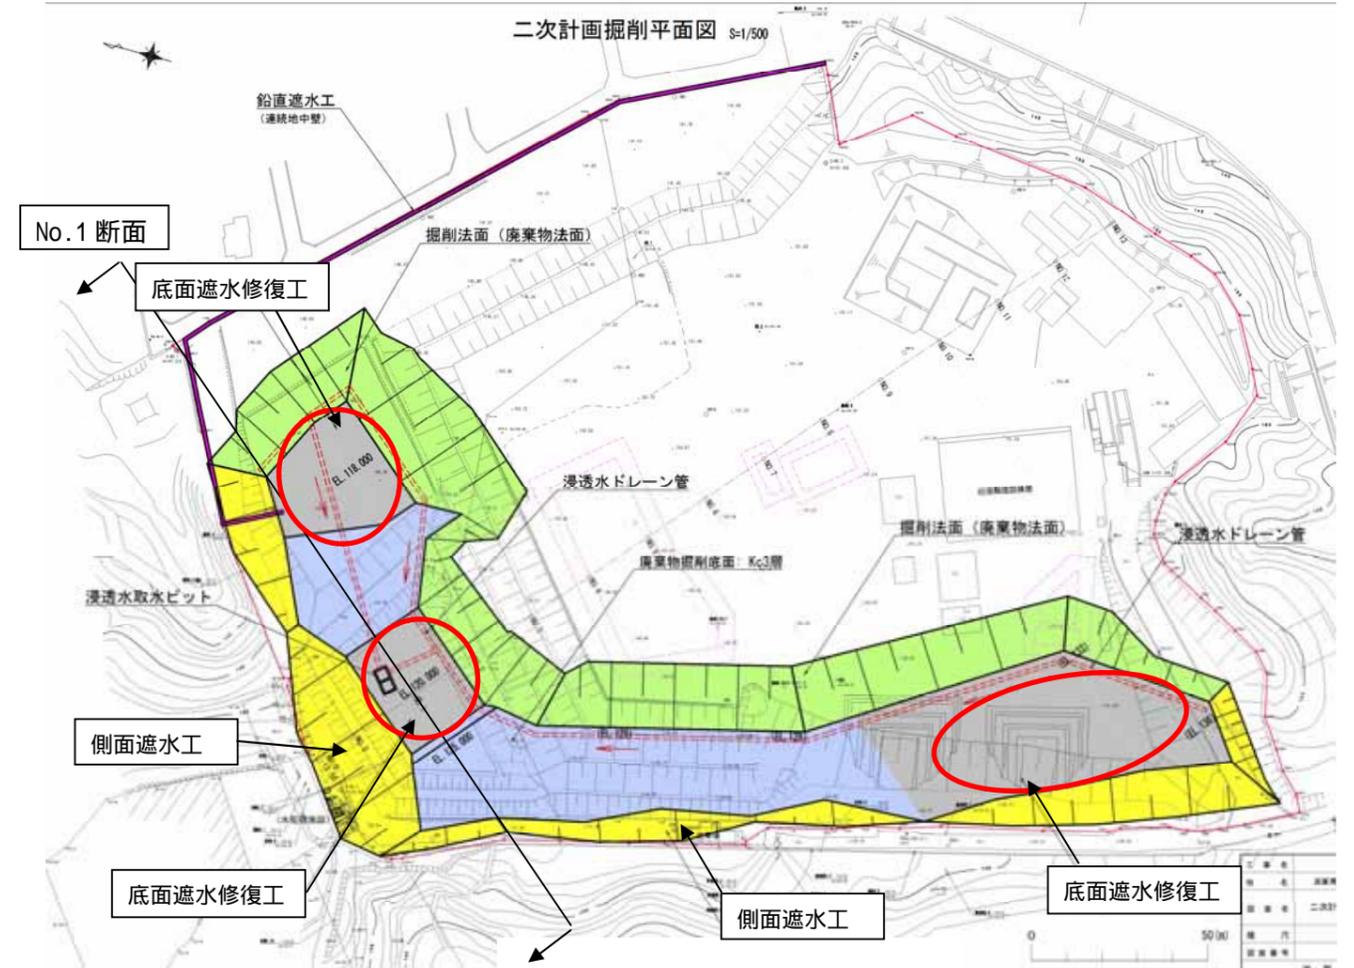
廃棄物土掘削計画平面図と底面遮水修復工および側面遮水工の施工範囲
